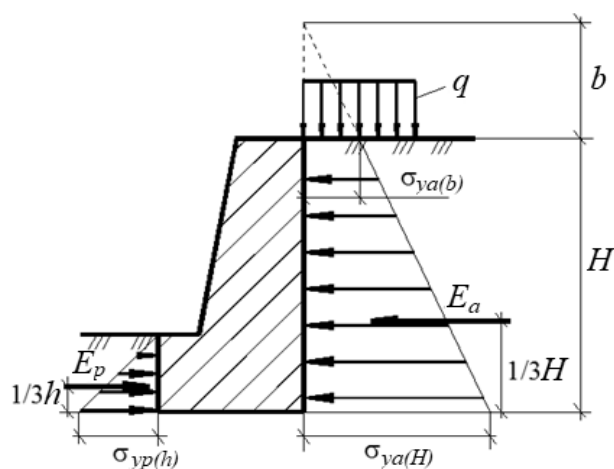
Расчетная схема подпорной стены при определении давления от идеально сыпучего грунта с учетом пригрузки
